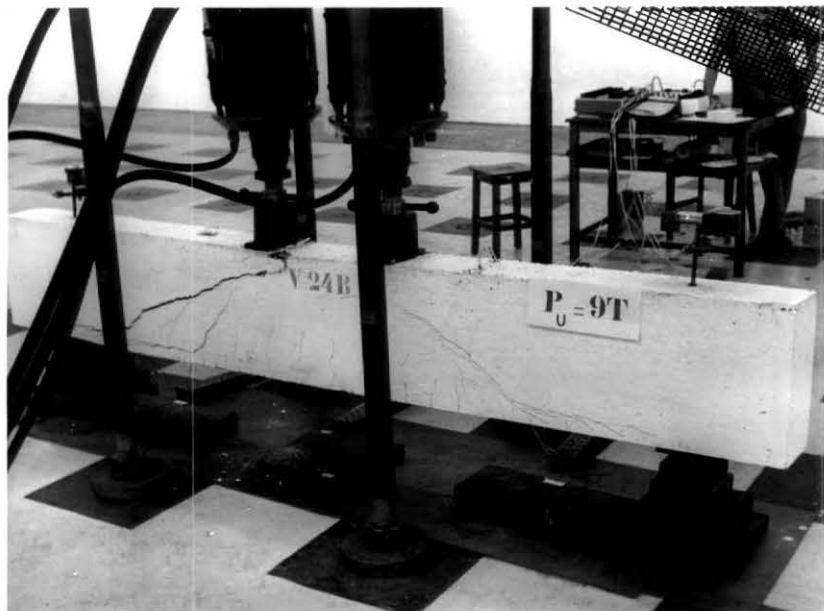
Vista da outra face da viga 24B notando-se, à esquerda, o concreto esmagado sob a carga.
